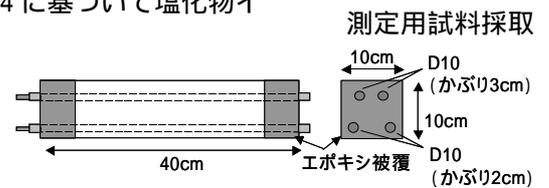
鉄筋腐食性検討供試体(ひび割れなし)
